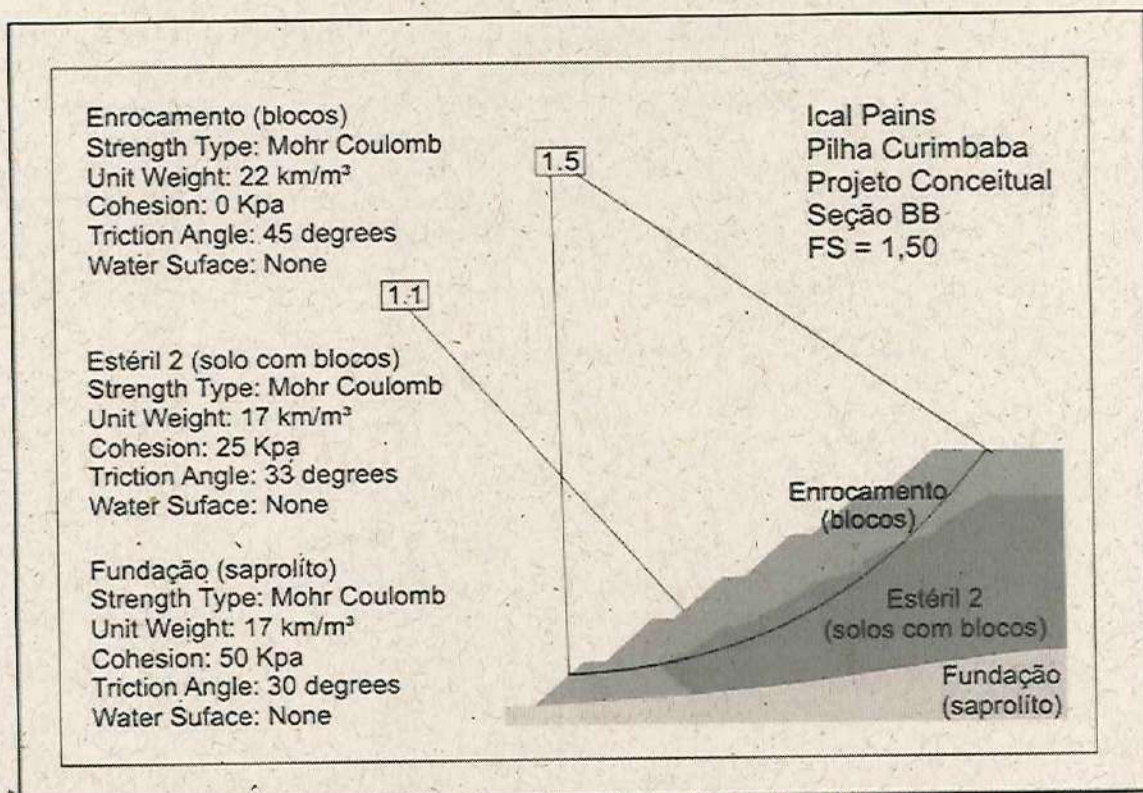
Seção do projeto executivo da pilha de estéril (Fonte: EIA - ICAL)
